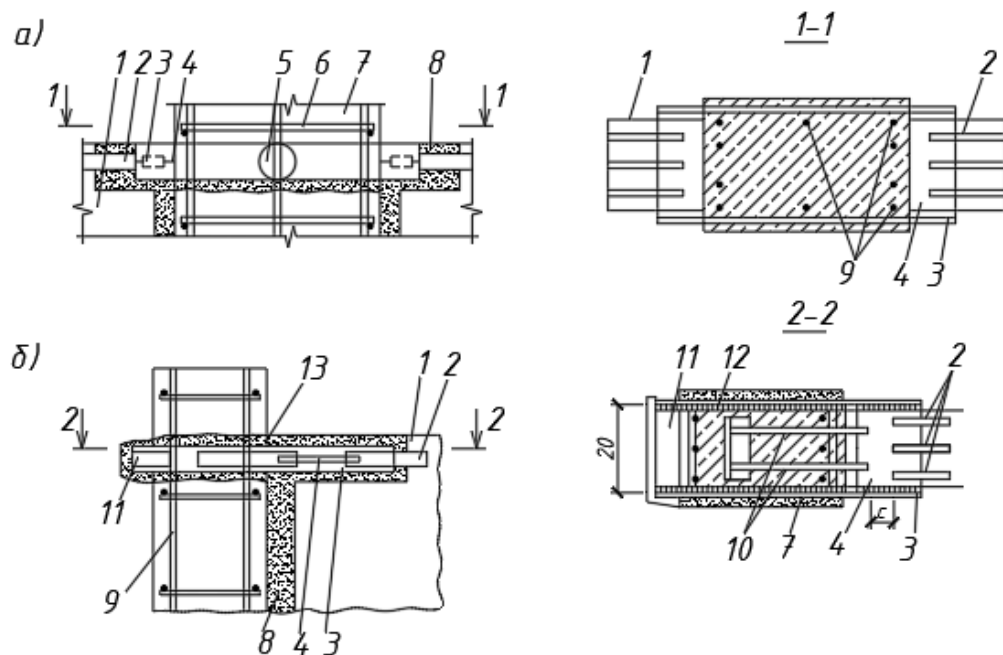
Підсилення стиків ригелів з колоною: а - при відсутності випусків арматури з колони; б - при недостатній кількості випусків арматури з колони; 1 - ригель; 2 - арматура ригеля; 3 - бічна планка хомута; 4 - горизонтальна планка хомута; 5 - стикова накладка; 6 - бічні пази, пробиті в бетоні і заповнені цементним розчином; 7 - колона; 8 - місця закладання розчином; 9 - поздовжня арматура колони; 10 - випуски арматури з колони; 11 - упорна планка; 12 - зварні шви; 13 - зазор для бетонування
